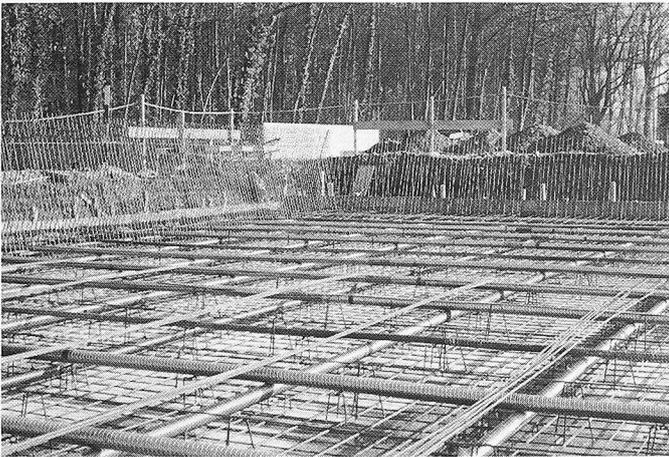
Becken-Bodenplatte mit Vorspannkabeln und Armierungen
